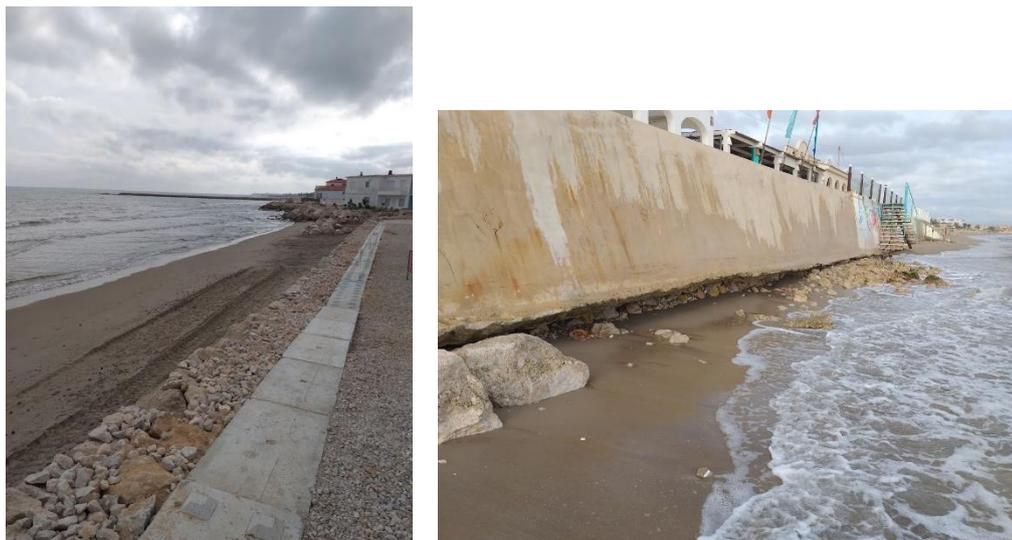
Defensa Longitudinal: Muros de hormigón subtramo 1 (Fuente: Elaboración propia)
